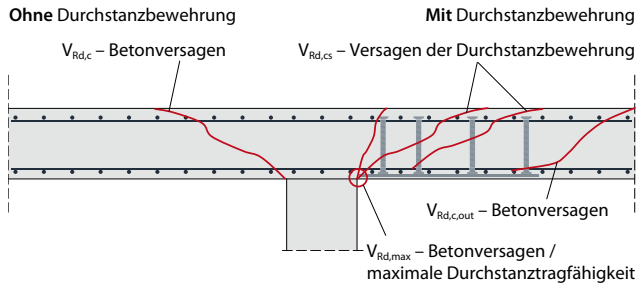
Versagensformen im Bereich ohne und mit Durchstanzbewehrung
